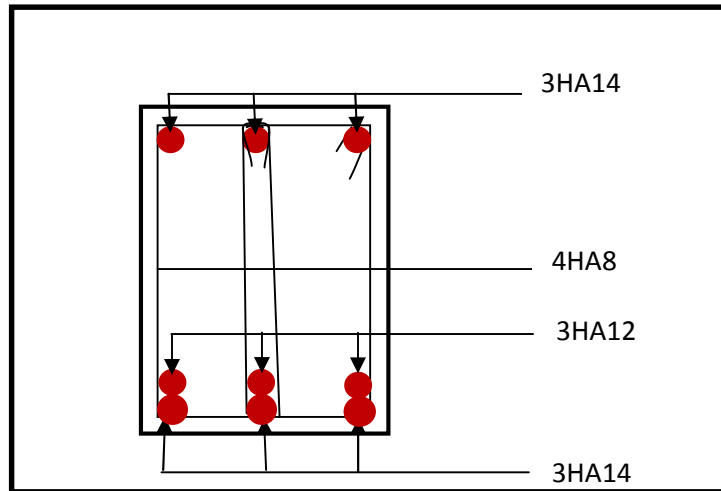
Ferrailage en travée d'une poutre secondaire.
